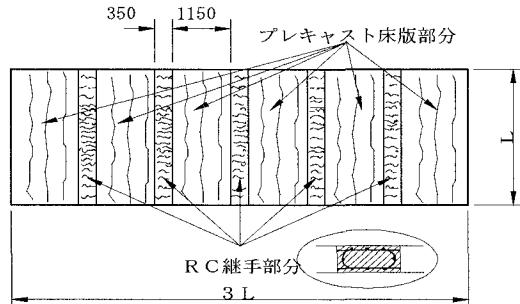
床版下面のひび割れと直交異方性版モデル
